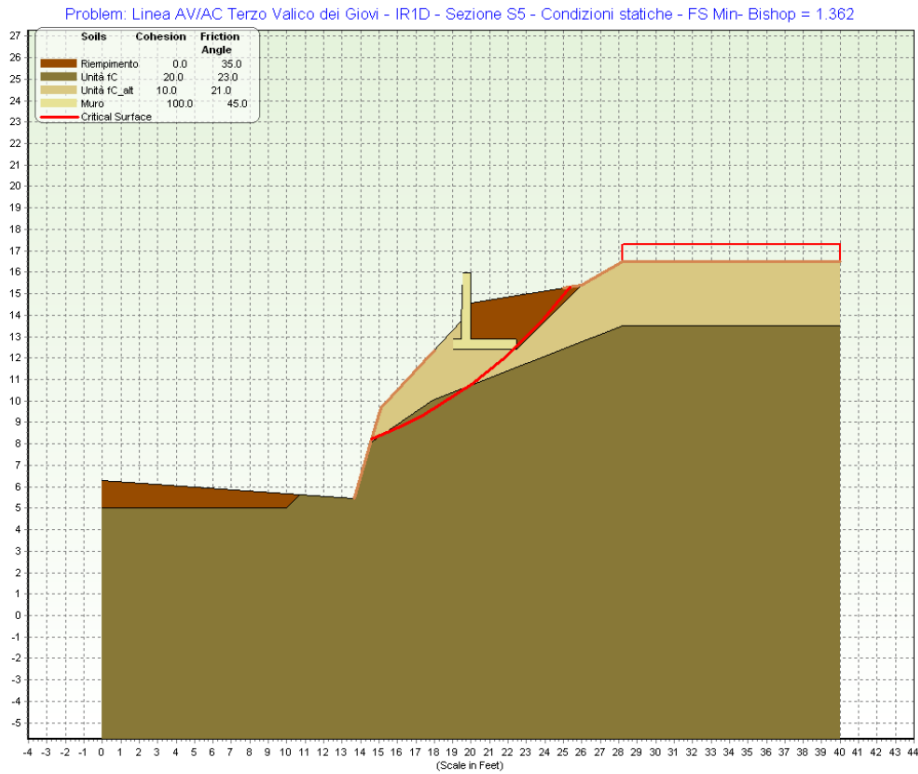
Verifica di stabilità locale condizioni statiche sezione pk 0+108.42
